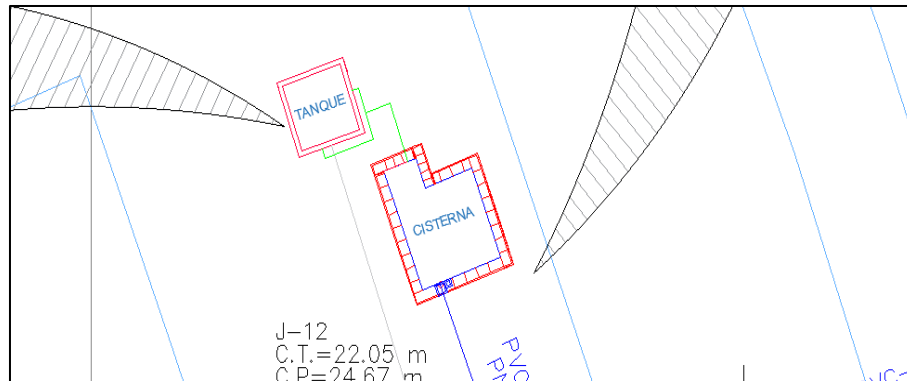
Planteamiento de estructuras Hidráulicas en AutoCAD
